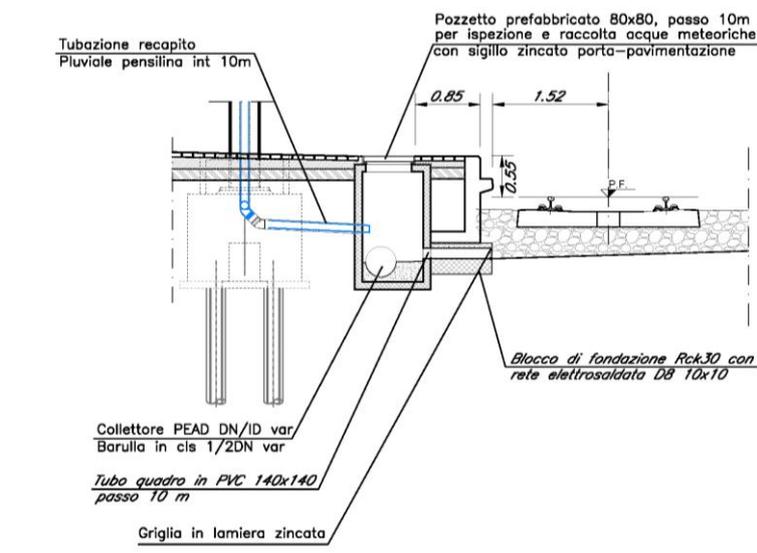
Drenaggio tra marciapiedi – Sezione interasse 10m con recapito pluviali pensilina
